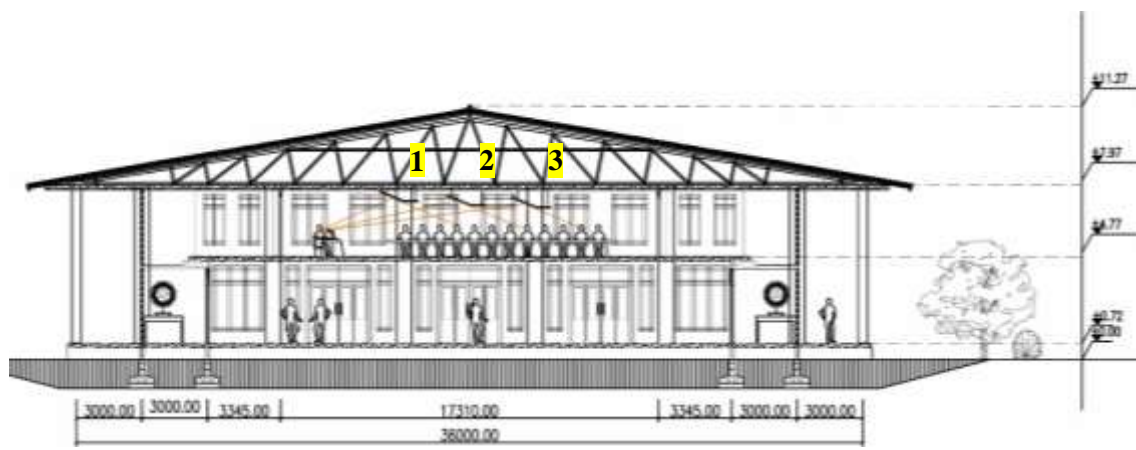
Rekomendasi desain penambahan elemen gantung pada plafond di ballroom
